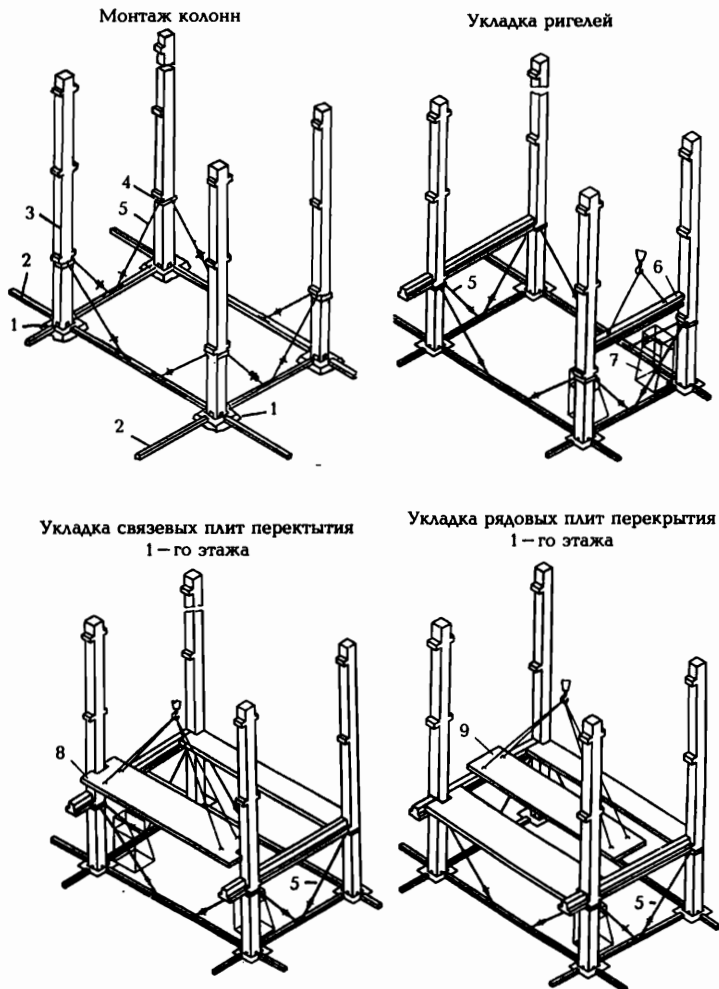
Монтаж элементов каркаса с помощью комплекта оснастки конструкции ЦНИИОМТП: 1 – фундаменты стаканного типа; 2 – обвязочные балки; 3 – колонны; 4 – хомут; 5 – подкосы для выверки и временного крепления; 6 – ригель; 7 – монтажная площадка; 8 – связевая плита; 9 – рядовая плита
